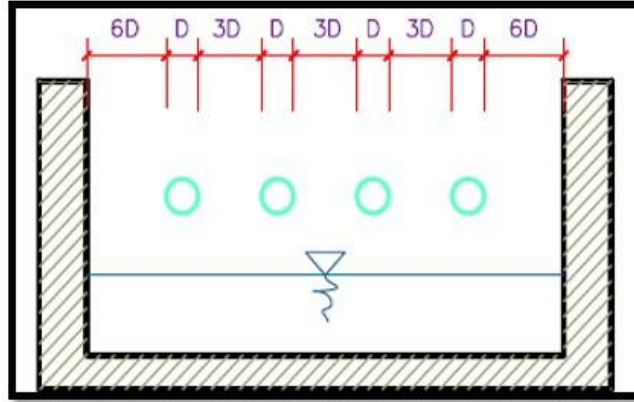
Determinación del ancho de pantalla Fuente: Ministerio de vivienda, construcción y saneamiento. (2018)
